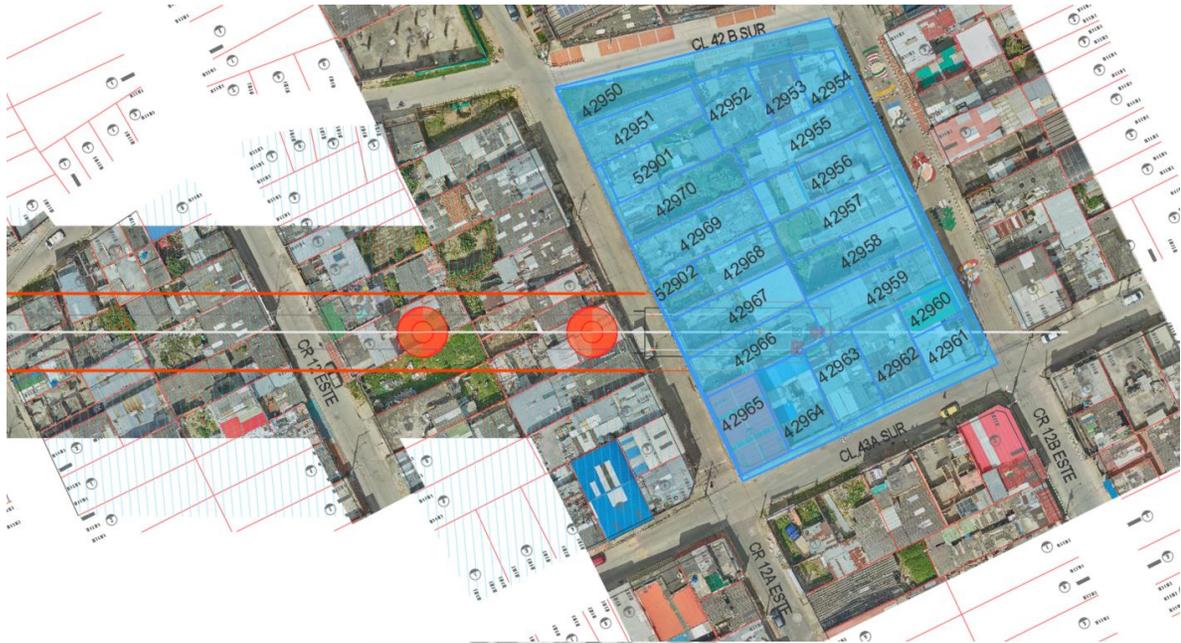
Planta – Perfil, Pilona 20, Pilona 21, Pilona 22
